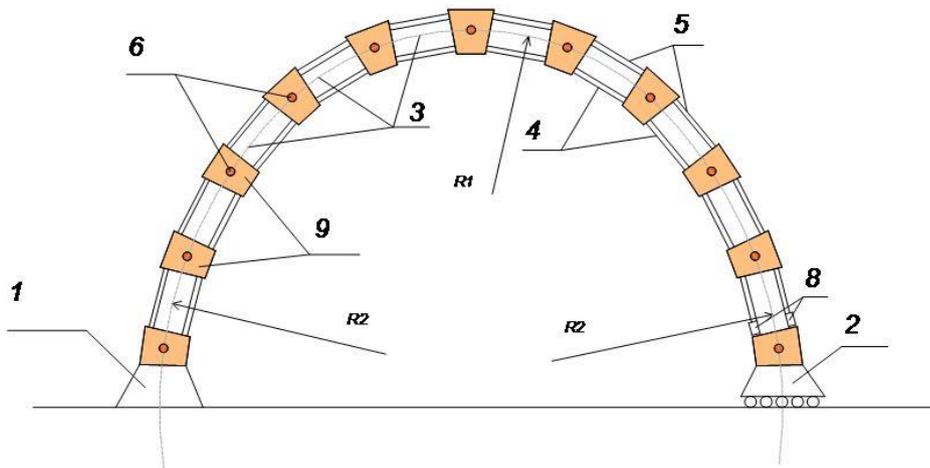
Место установки углового фиксатора и соединительной шпильки в АММК совмещены:
